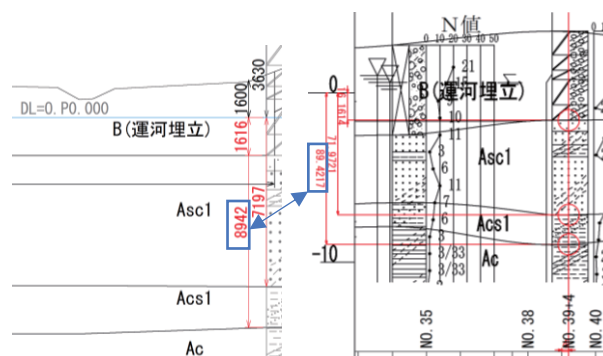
横断面図(左)と縦断面図(右)の地層境界のチェック例
